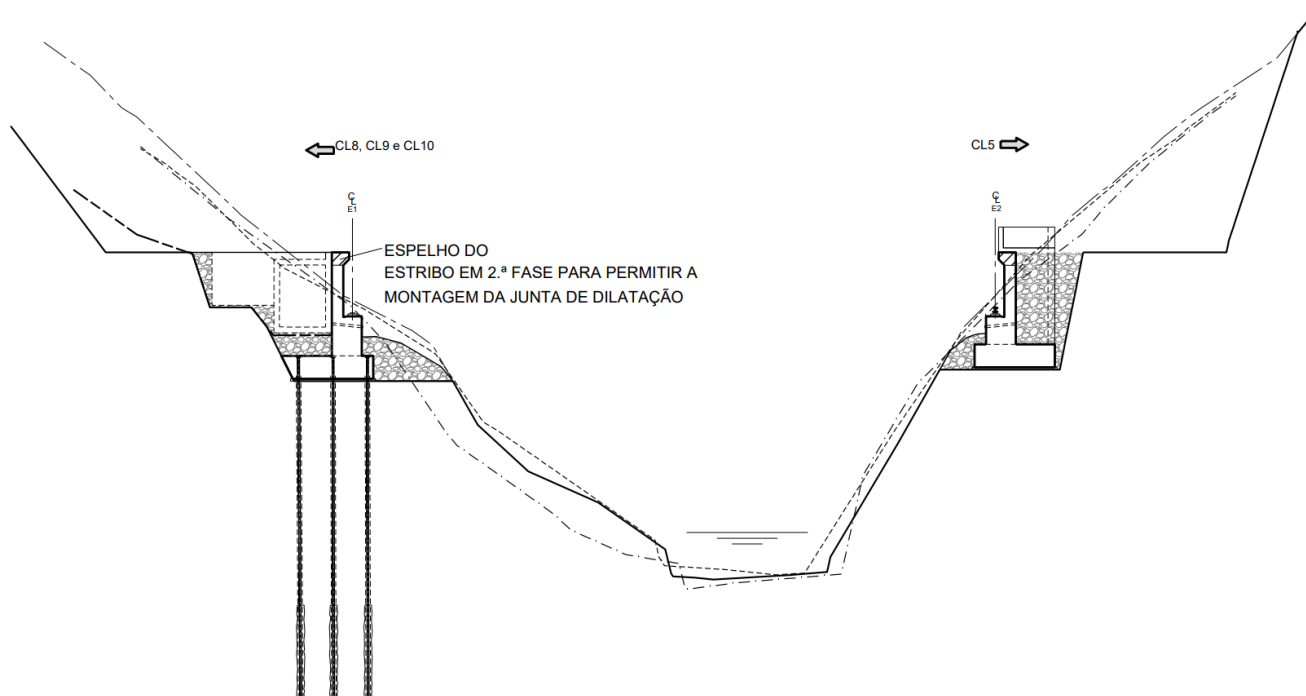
FASE III – Execução de aterros e preenchimento das escavações provisórias
